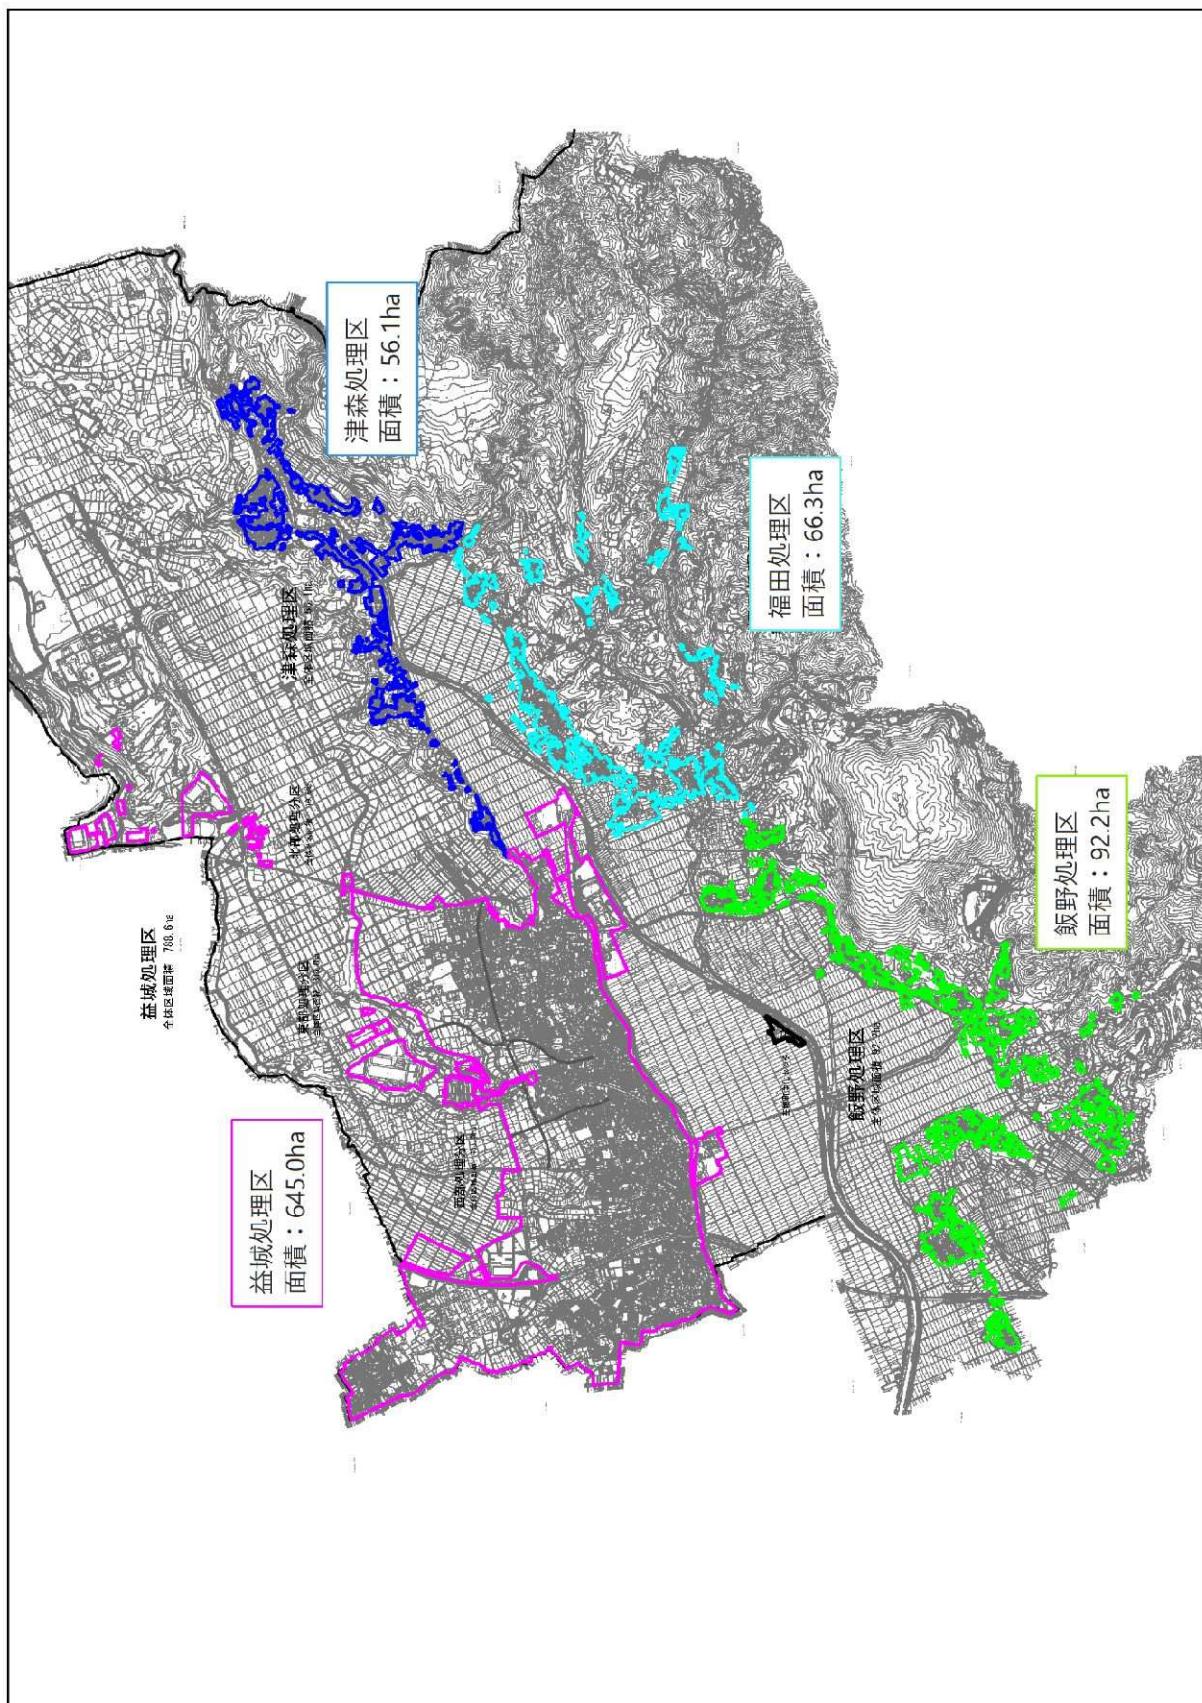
益城町公共下水道 全体計画汚水一般平面図
